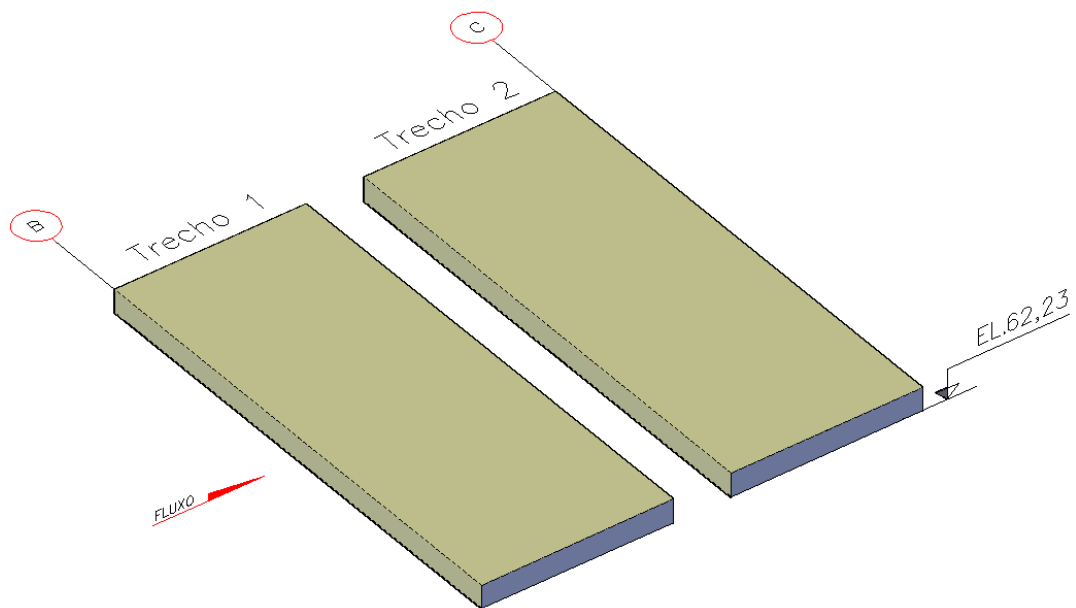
Laje Central Eixos B e C – Divisão dos Trechos – Visualização 3D
